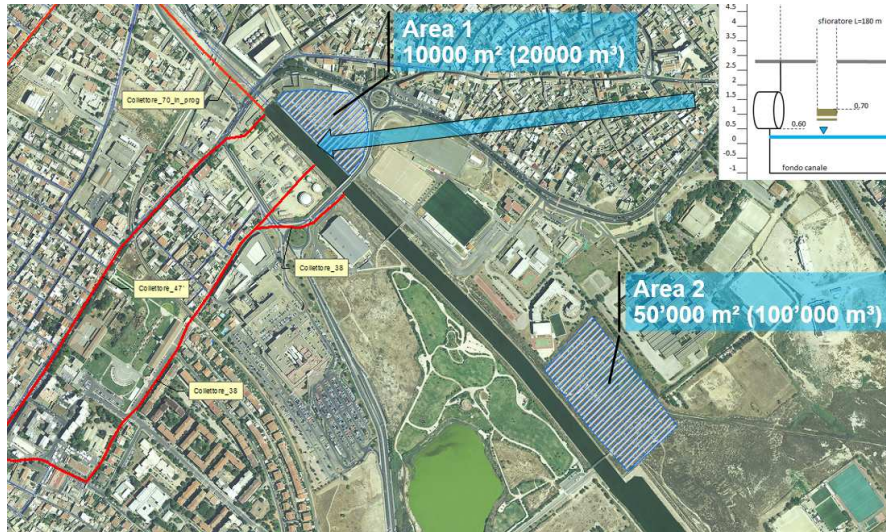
Planimetria schematica degli interventi sul canale Terramaini
